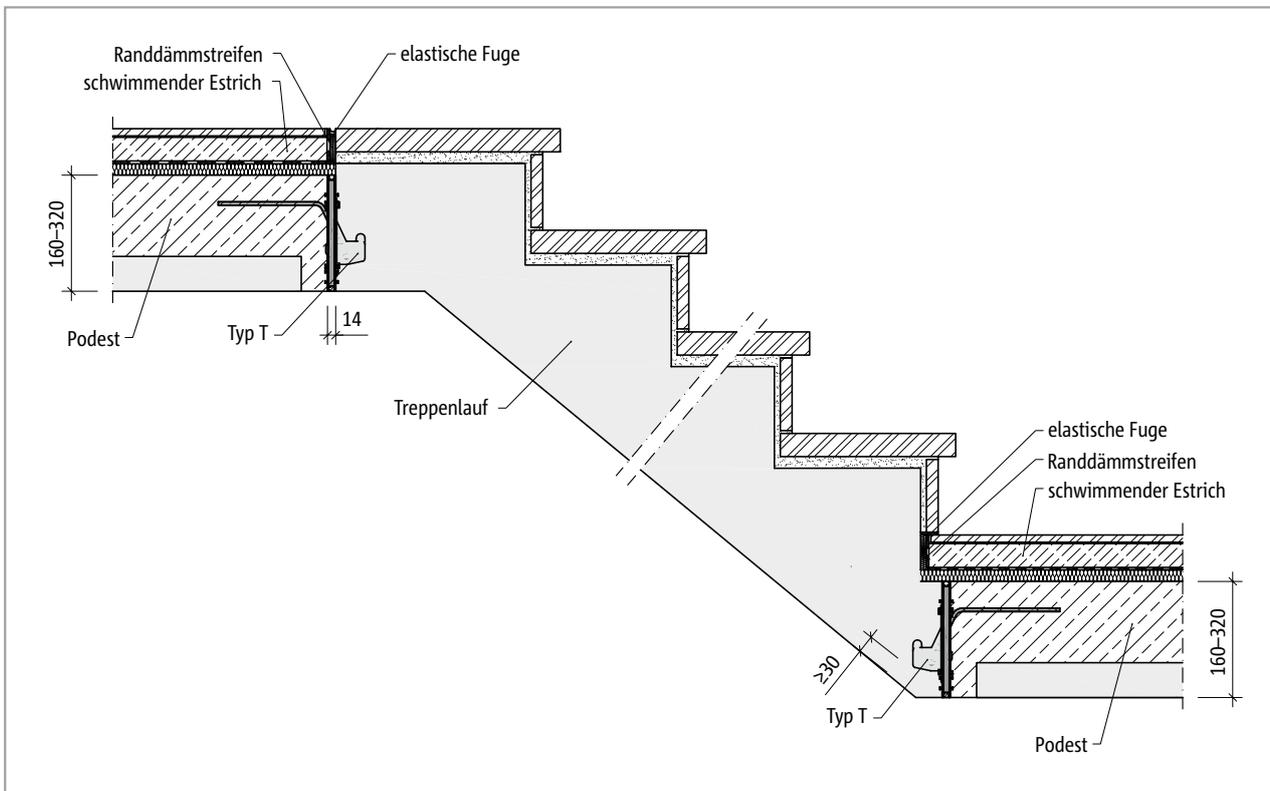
Schöck Tronsole® Typ T: Einbauschnitt Fertigteilterrasse mit Halbfertigteilpodest
